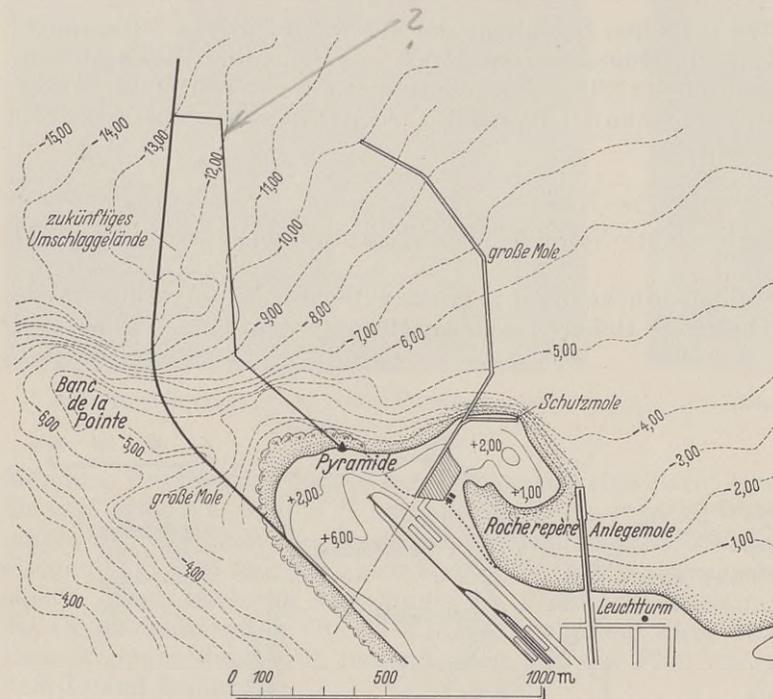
Lageplan des Seeschiffhafens Pointe Noire.
